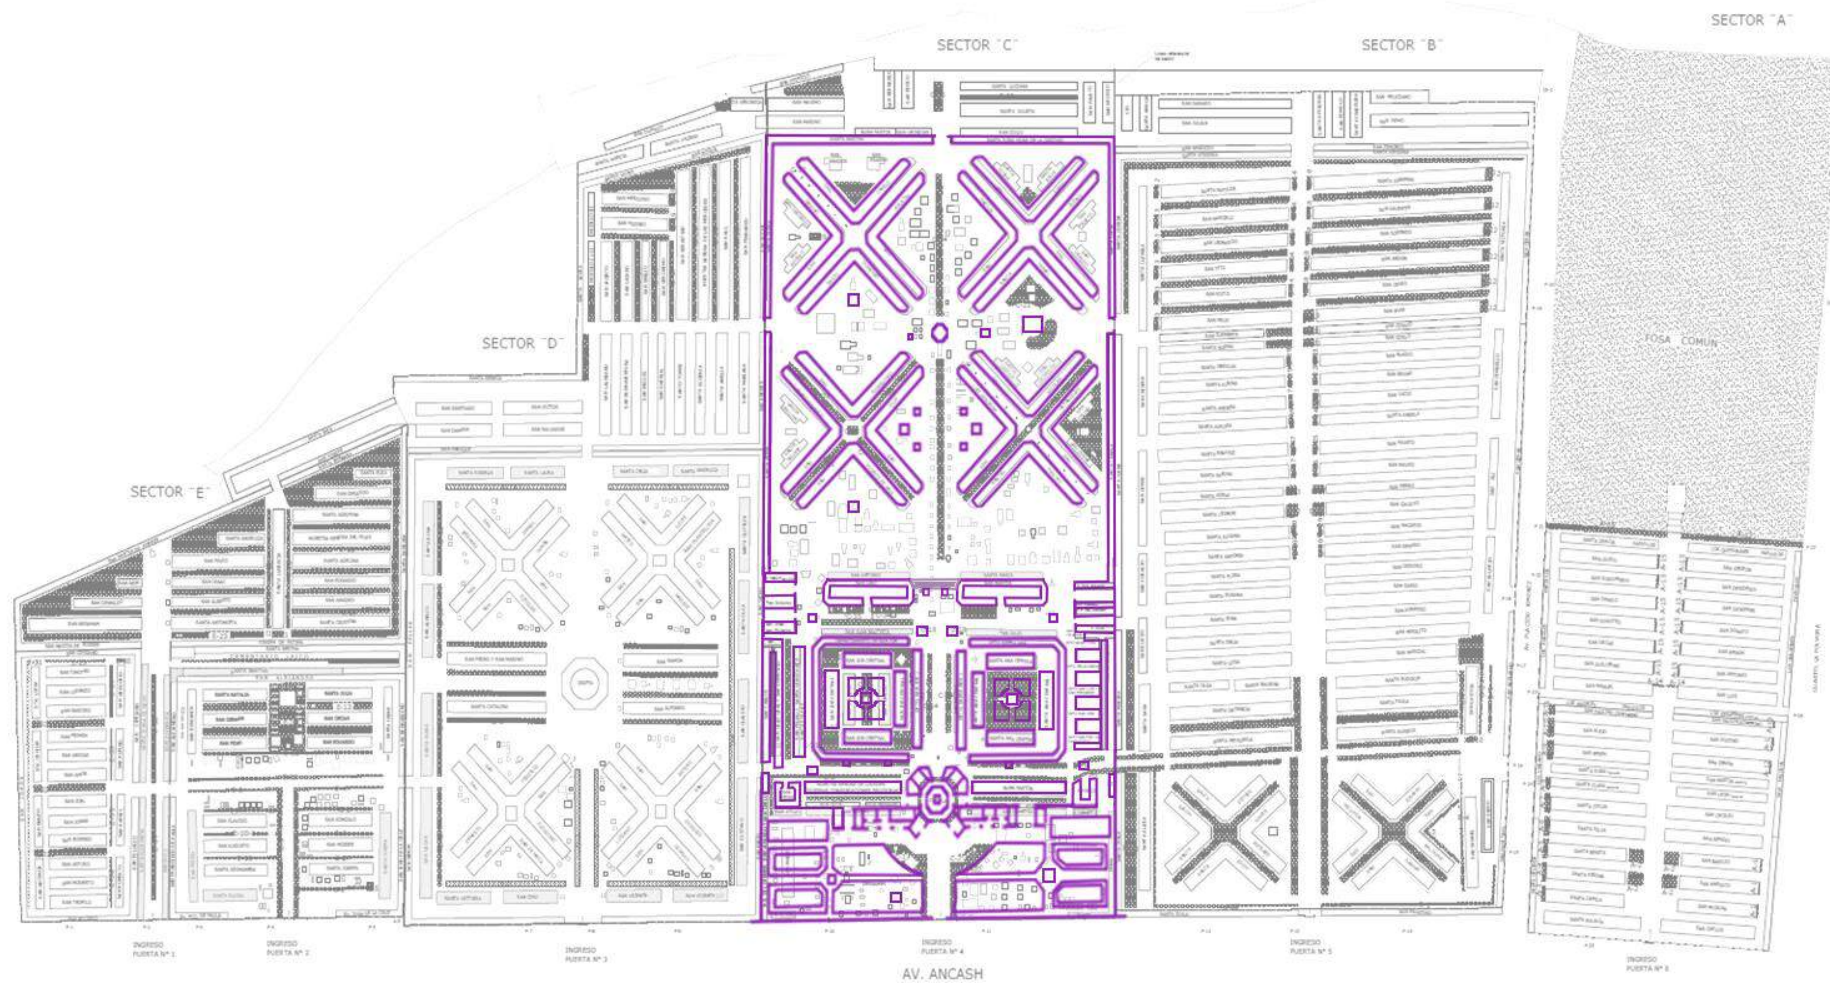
Plano de 1890 sobrepuesto al plano actual. Fuente: Elaborado por la autora en base a plano actual y plano de 1890.
